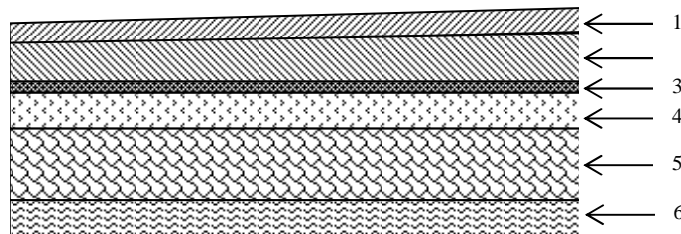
Coupe verticale de plancher terrasse en dalle pleine
